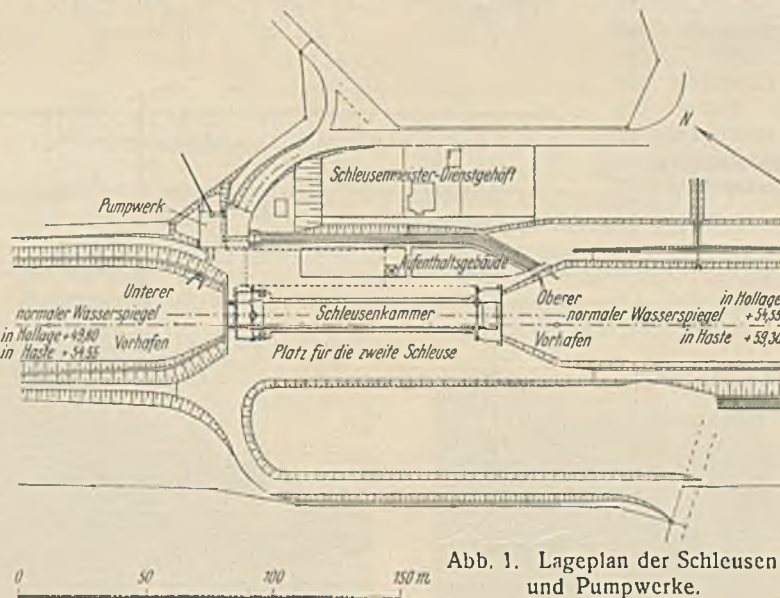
Lageplan der Schleusen und Pumpwerke.
